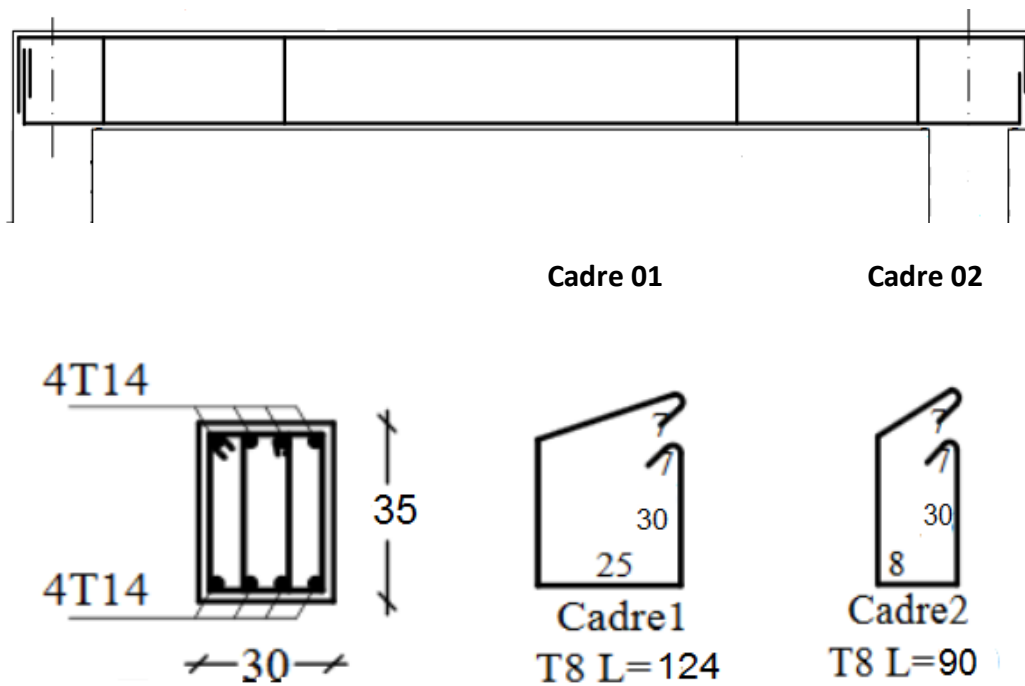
ferraillage de la poutre secondaire (30×35)
